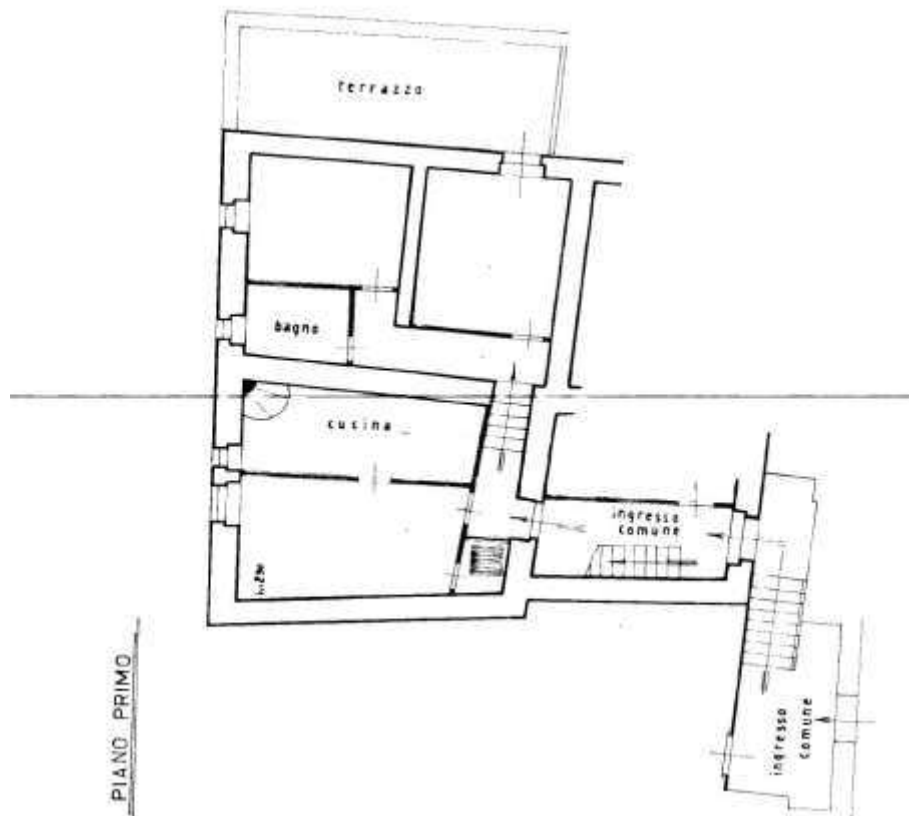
Planimetria particella 21 sub 1- Piano Primo
